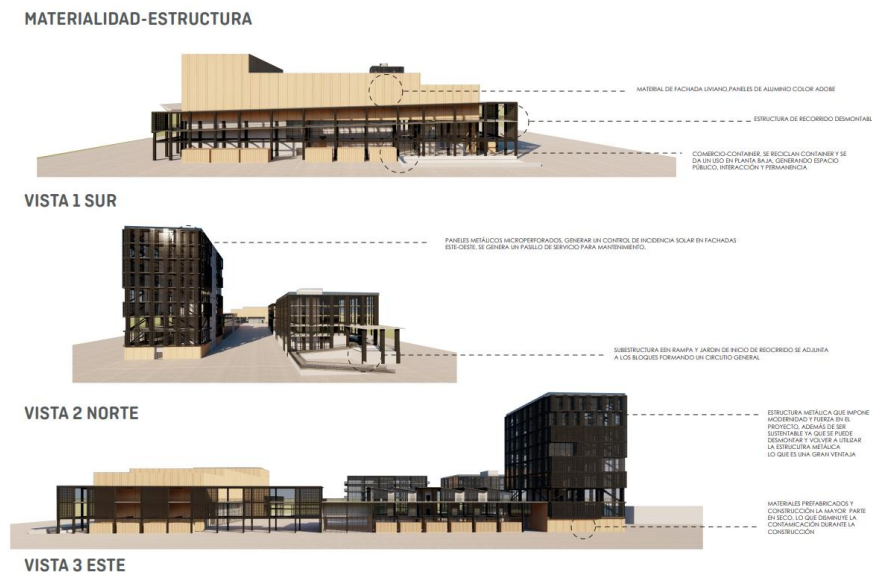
Estrategias de Envolvente y Fachada Ventilada. Fuente: Elaboración Propia
